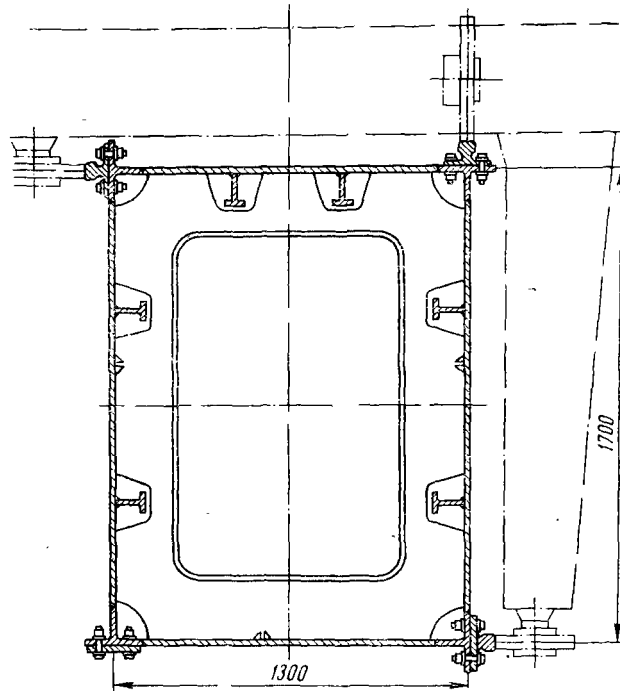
Сварная подкрановая балка из алюминиевого сплава
